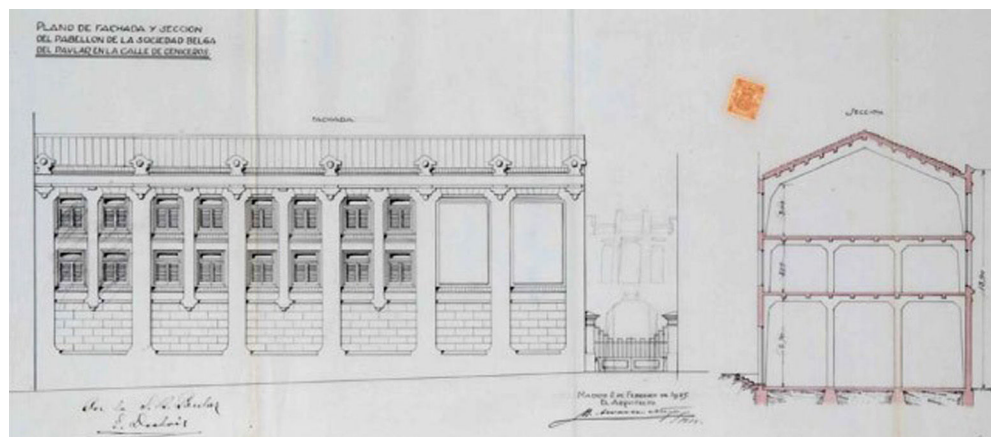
Planos originales del edificio del arquitecto Manuel Álvarez Naya (1925). En la sección se pueden apreciar los elementos estructurales: pilares, vigas, viguetas y forjados.
